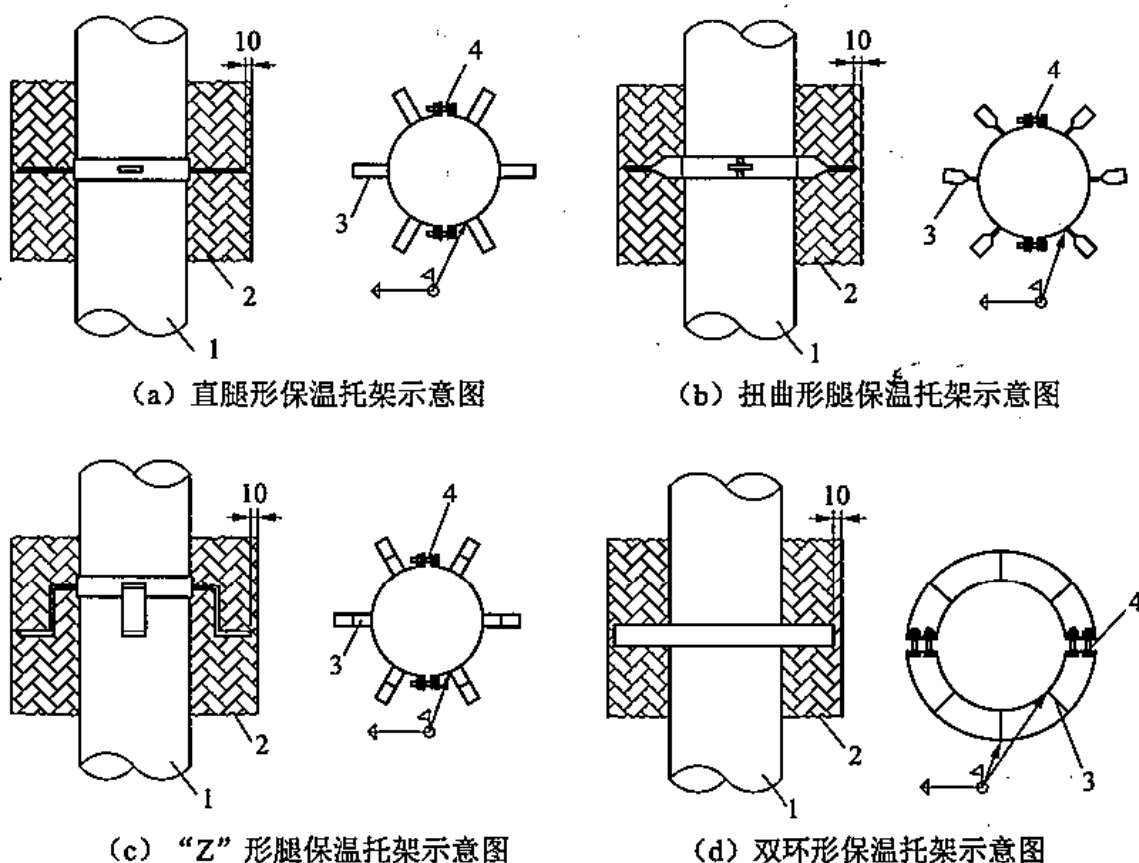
管道保温托架示意图 (单位: mm)
